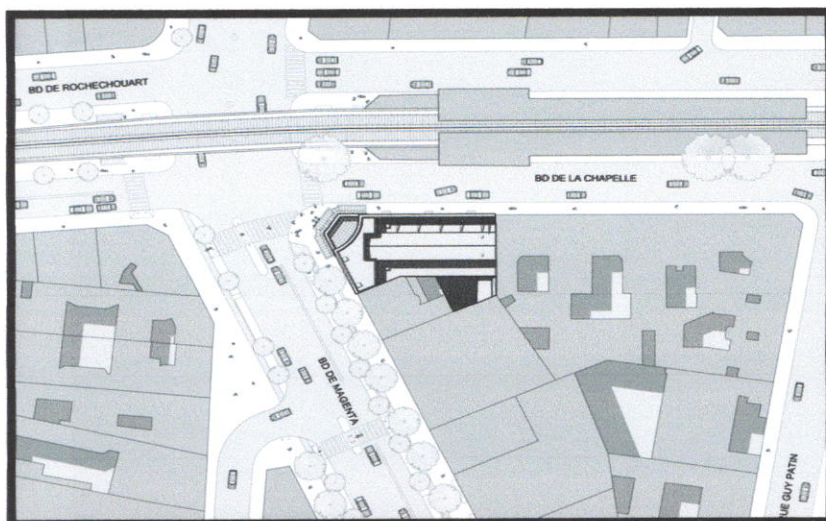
plan de masse de « Louxor », source : [.pumain](#).
